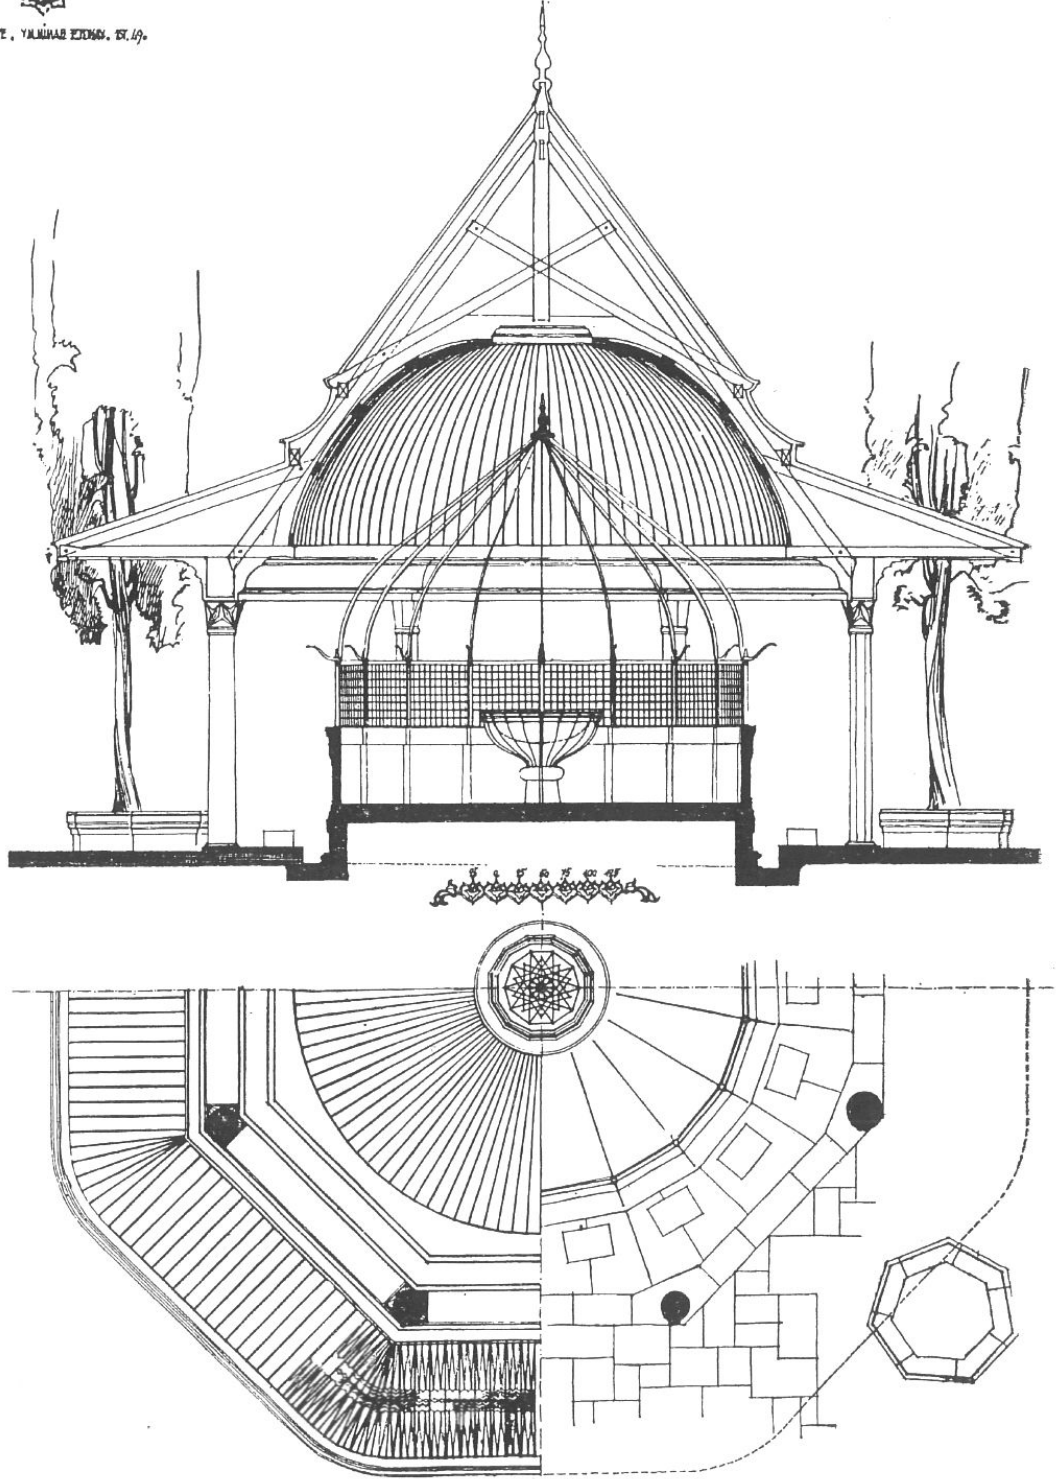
Fatih Camii Şadırvanı Plan ve Cephesi¹⁷⁵
